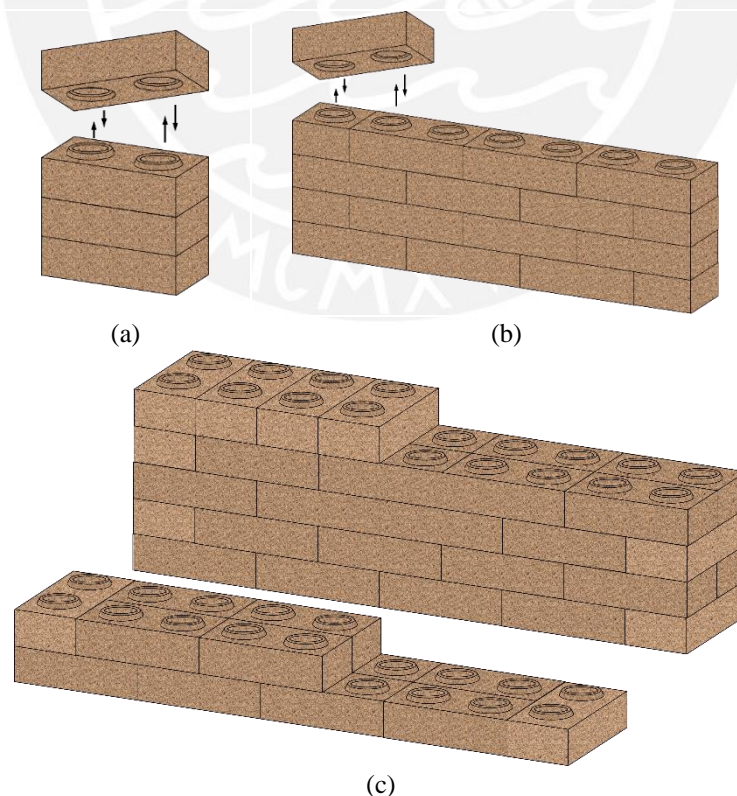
Sistema de albañilería de BTC-E: a) pilas, b) muretes y c) muros
